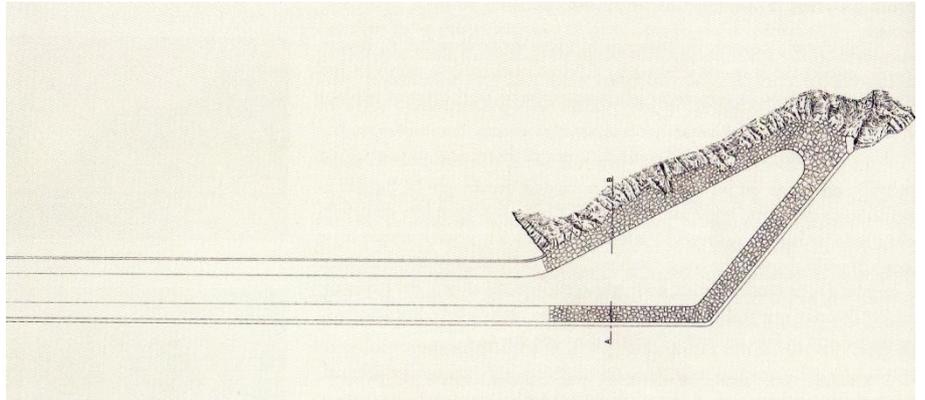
Proyecto de pavimentación del ingeniero municipal para la Plaza del Tenis.
